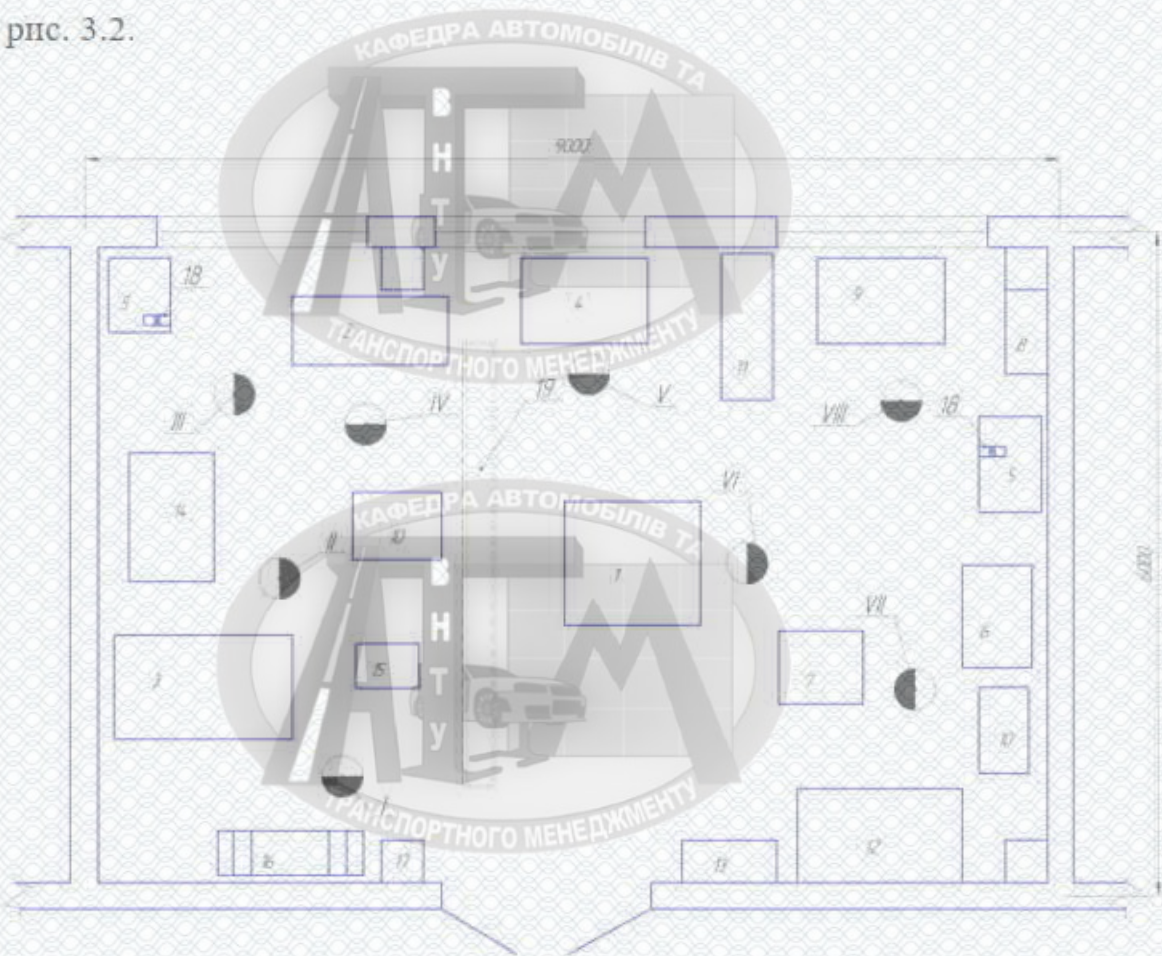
Схематичне планувальне рішення агрегатно-механічної ділянки: 1 – поворотний стенд для вивішування двигунів; 2 – стенд для ремонту шатунно-поршневої групи; 3 – стенд для опресування головок блоку циліндрів; 4 – мюча ванна для деталей; 5 – слюсарний верстак; 6 – токарно-гвинторізальний верстат; 7 – прес гідравлічний; 8 – стенд для клепання гальмівних накладок; 9 – плоскошліфувальний верстат; 10 – заточний верстат; 11 – стенд для ремонту коробок передач; 12 – стелаж для деталей; 13 – шафа для ганчір'я; 14 – настільний свердлильний верстат; 15 – настільний прес на підставці; 16 – стелаж для інструментів; 17 – шафа для відходів; 18 – лещата; 19 – підвісна кран-балка
